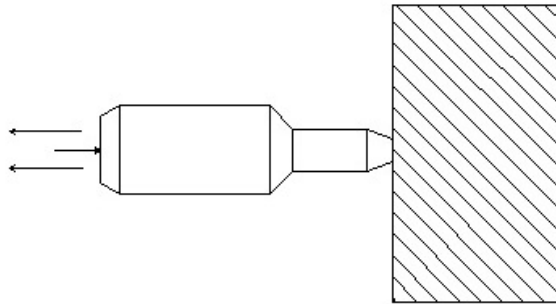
Схема випробувань бетону методом відскоку
